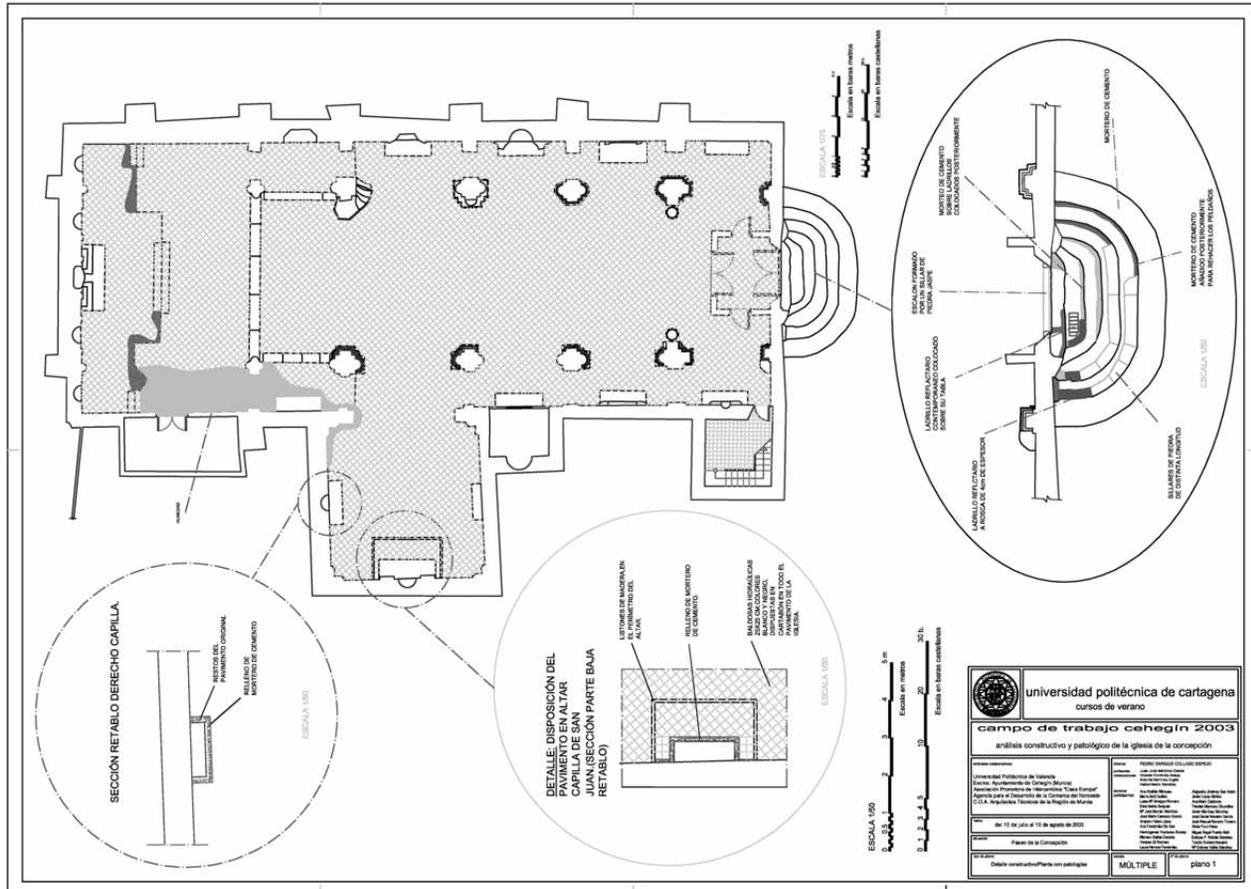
Plano de planta de la iglesia de la Concepción con definición de pavimentos y patologías detectadas.
